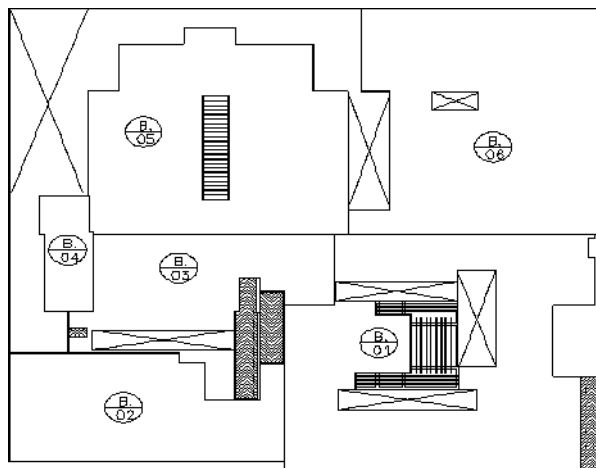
Planta Arquitectónica General del Hospital. Fuente: Elaboración propia
